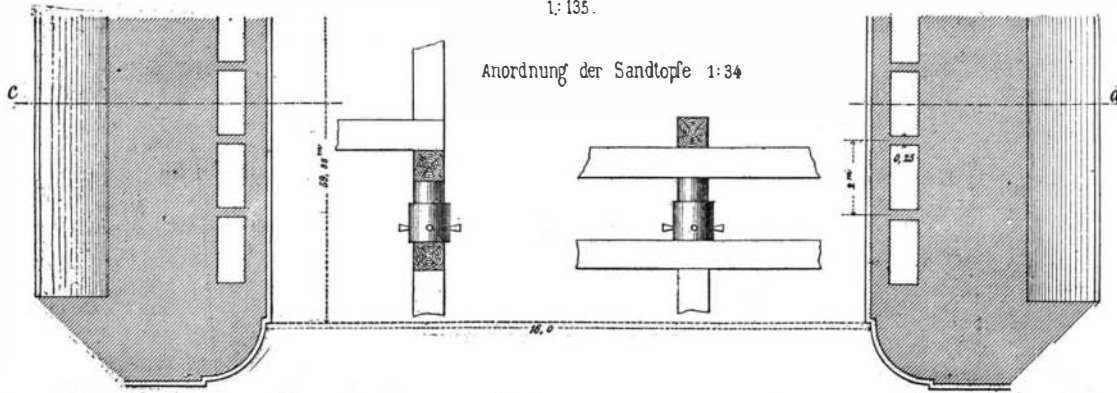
Grundriss nach a b (in Fig 2.)
